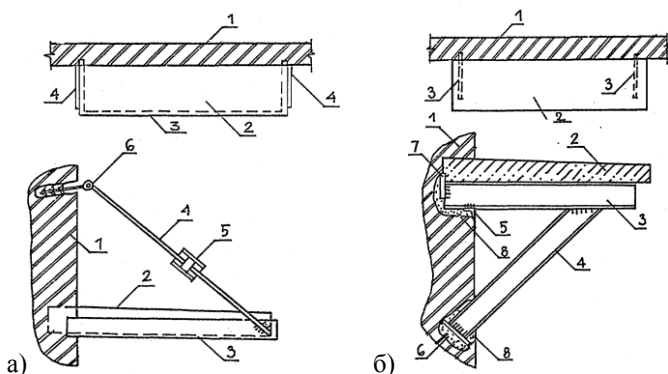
Схемы усиления: а) установкой тяжей: 1 – стена; 2 – балконная плита; 3 – обрамление из уголка с заделкой в стену; 4 – подвеска из арматурной стали; 5 – стяжная муфта; 6 – анкер с кольцом на конце, установленный на растворе в просверленном в кладке отверстие; б) установкой подкосов из прокатного металла: 1 – стена; 2 – балконная плита; 3 – консоль из прокатного металла; 4 – подкос консоли из прокатного металла (двутавр, швеллер); 5 – опорный уголок; 6 – опорная пластина; 7 – анкерная пластина; 8 – ниша в стене (после установки подкосов заполняется бетоном)
